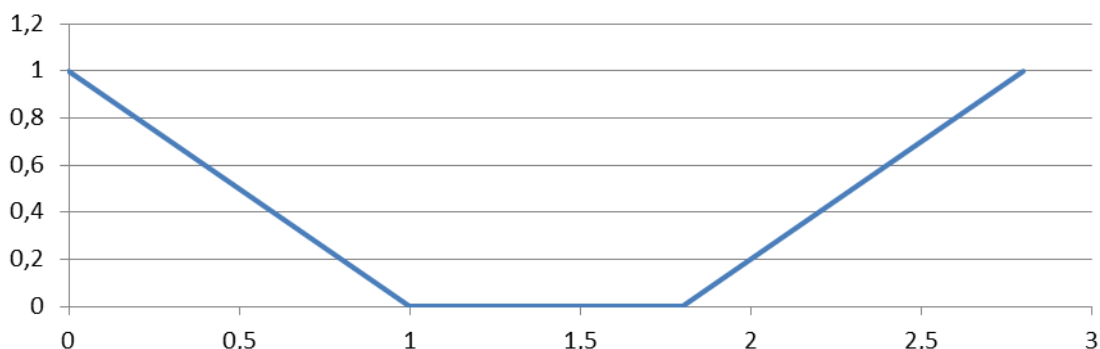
Principeprofiel voor aan te leggen beekloop bovenstrooms van vistrap 2.
